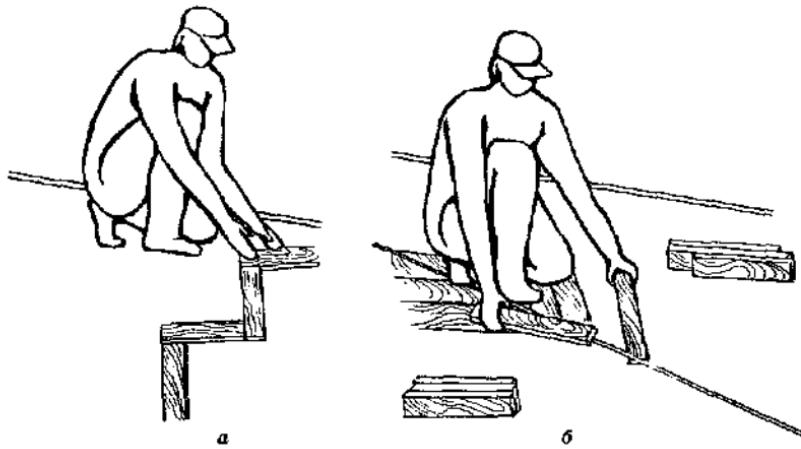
Предварительная раскладка планок насухо: а — раскладка змейкой; б — укладка маячной елки
